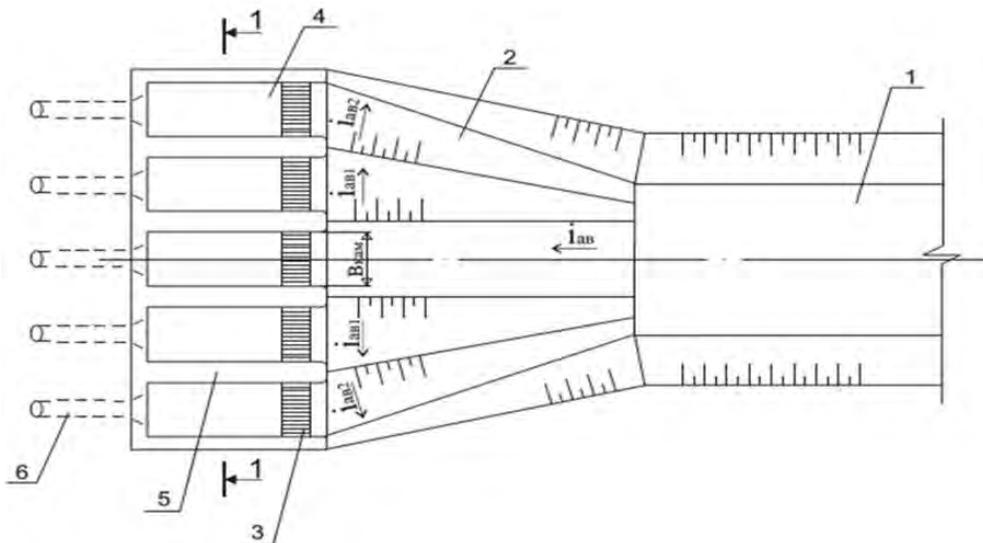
План водоприёмного сооружения полигонального поперечного сечения: 1 - подводящий канал; 2 - аванкамера; 3 – служебный мостик; 4 – водоприёмная камера; 5 – быки; 6 - всасывающий трубопровод
